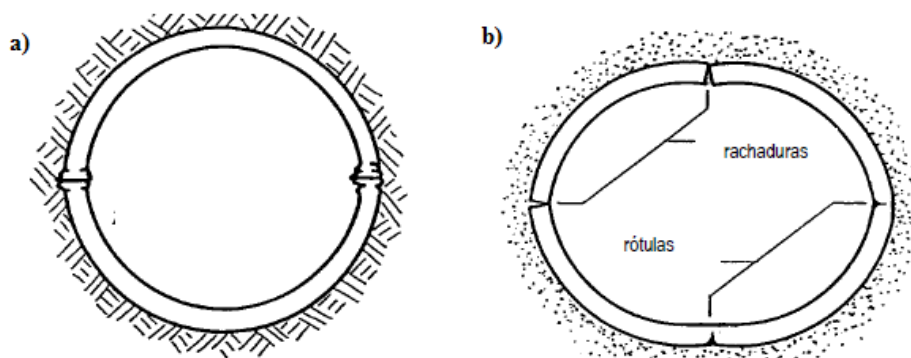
Deformações em dutos rígidos: a) Esmagamento da parede; b) Rachaduras e Rótulas plásticas (modificado de Rubio, 2008).
